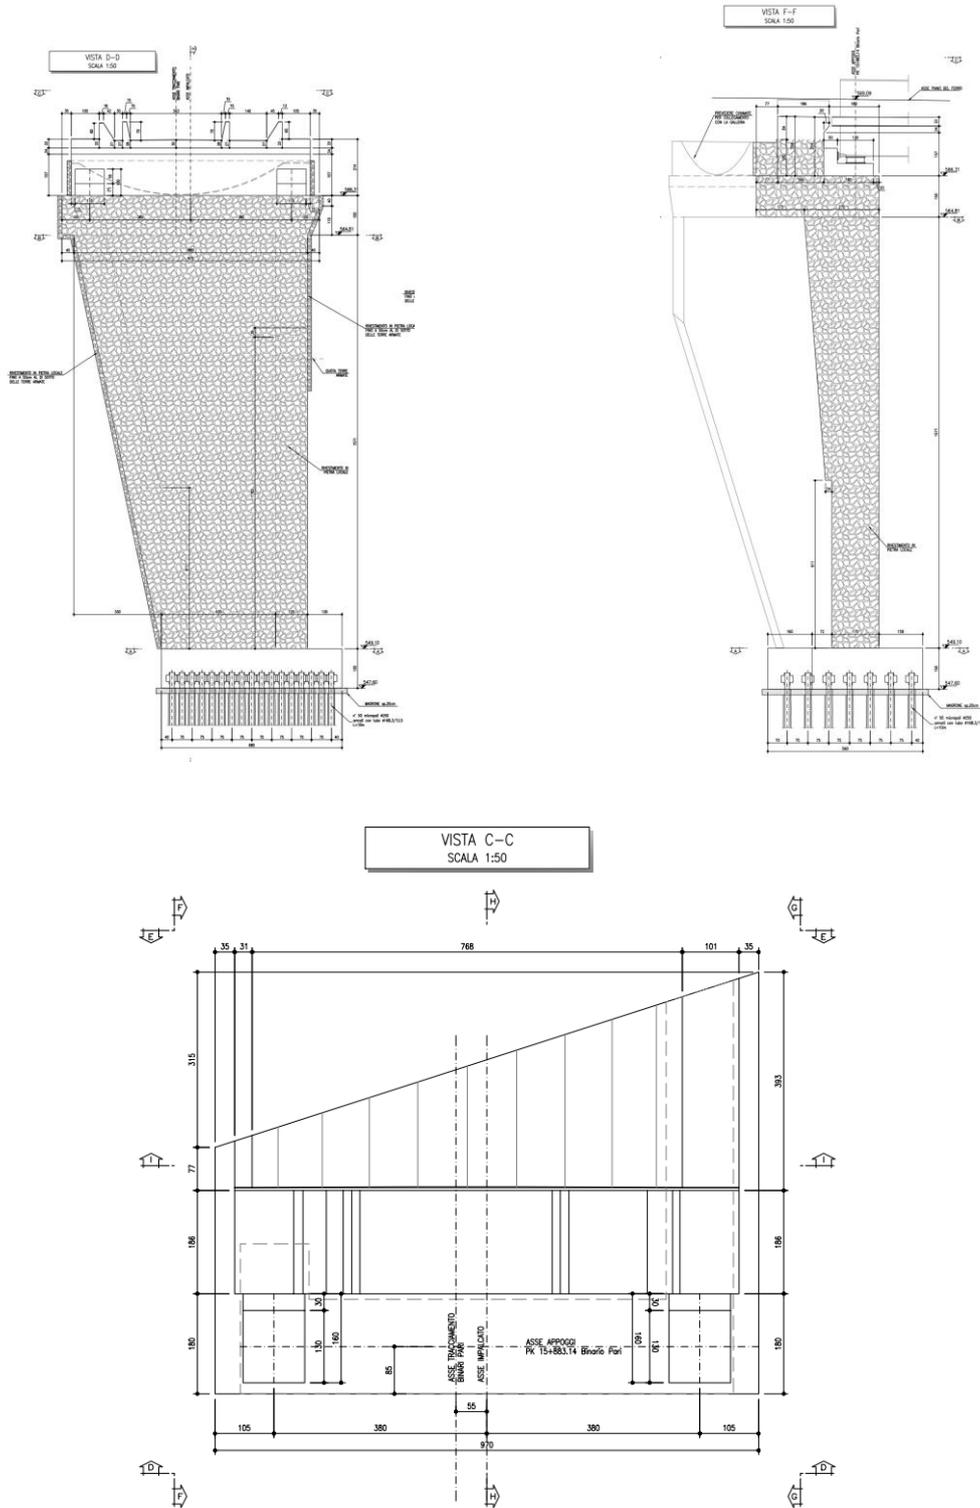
Spalla lato Scalares BP - Prospetto frontale, laterale e pianta
